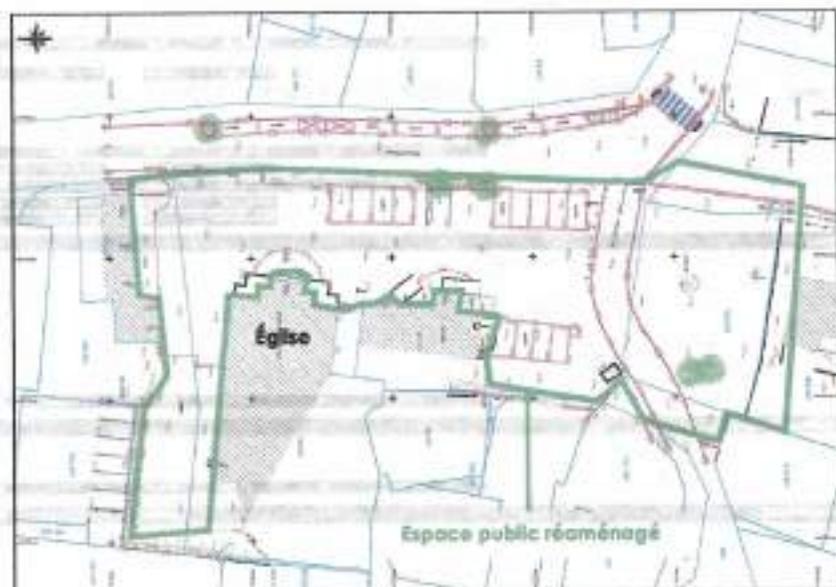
Plan géométrique du site étudié, avant travaux (place de l'église et de la mairie)
